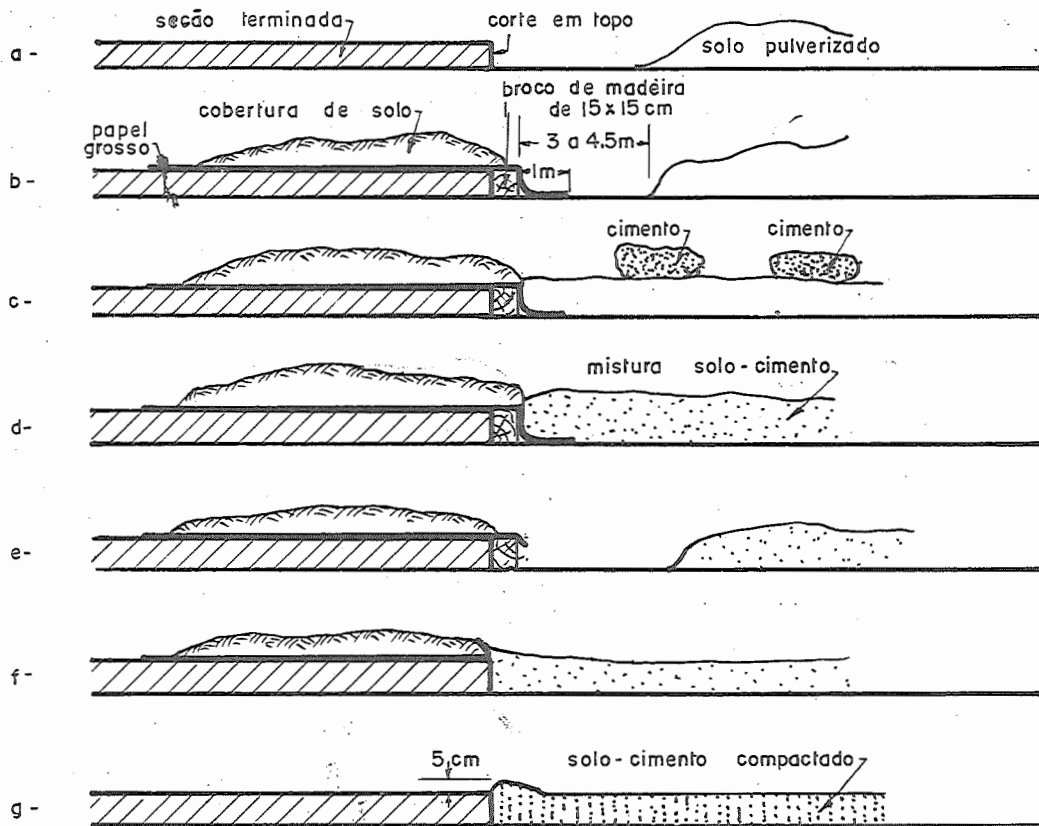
JUNTA DE CONSTRUÇÃO
